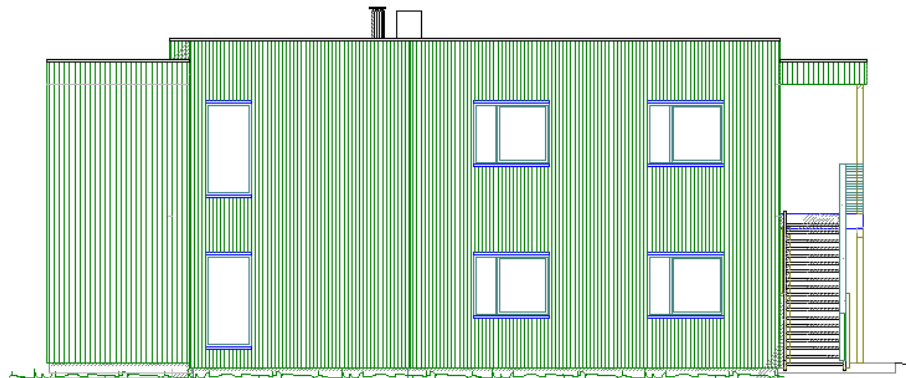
Firemannsbolig som er brukt i illustrasjonsplanen. Fasade øst.
